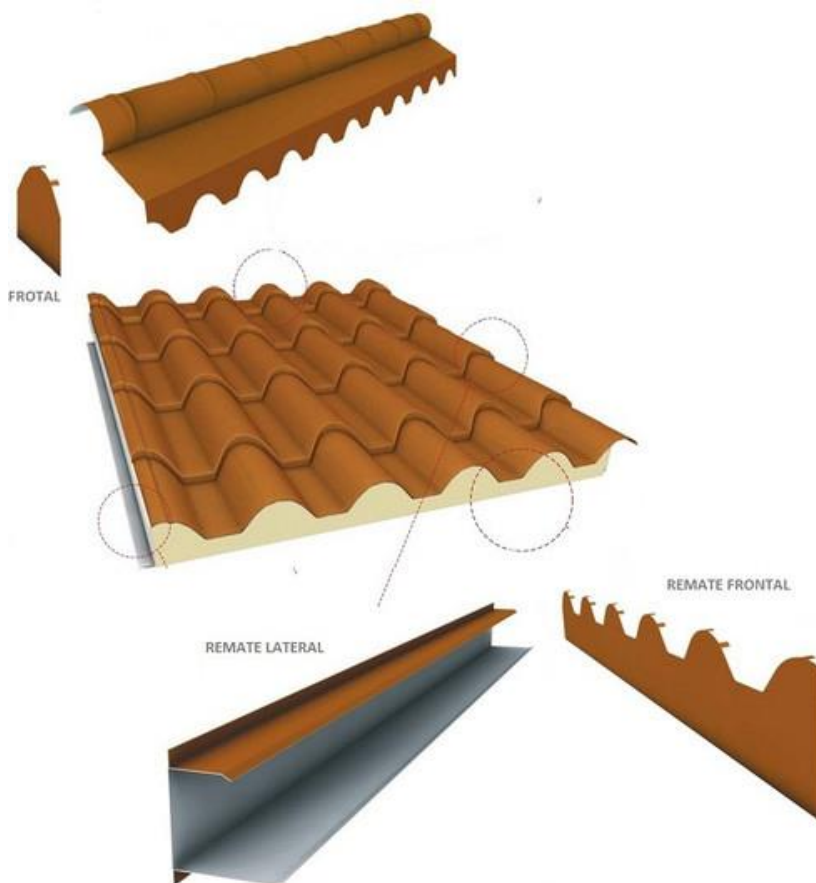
Tipos de remates existentes para as coberturas painel sandwich
